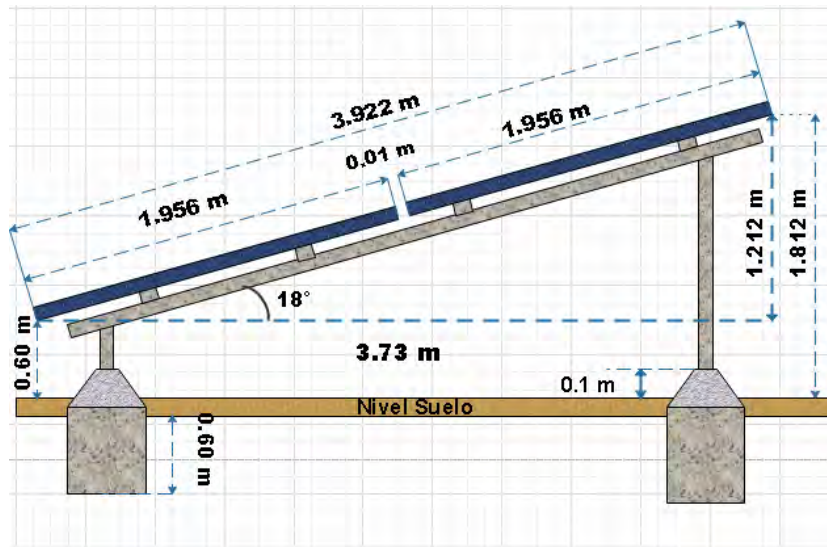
Corte transversal de la Estructura. (Fuente elaboración propia.)
